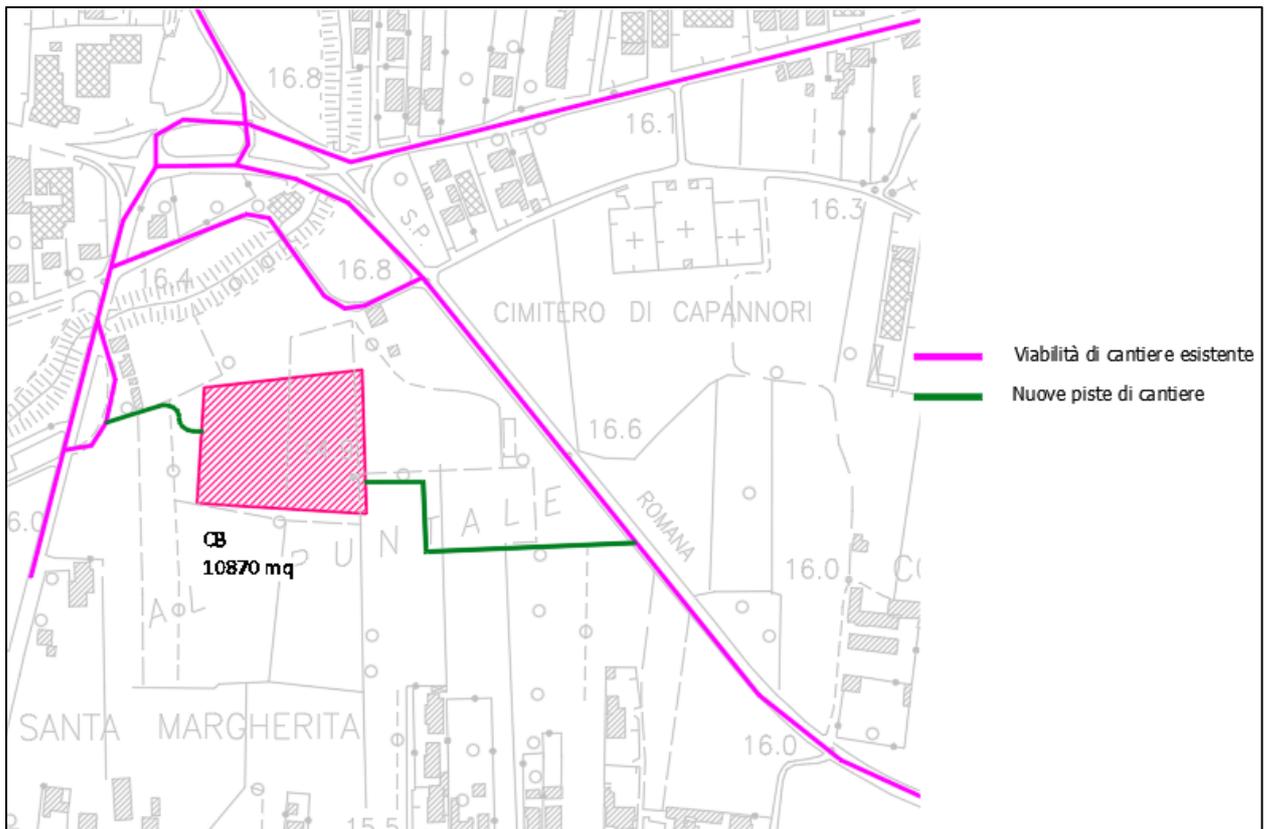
Collegamento del cantiere base CB con gli assi ovest-est ed est-ovest
